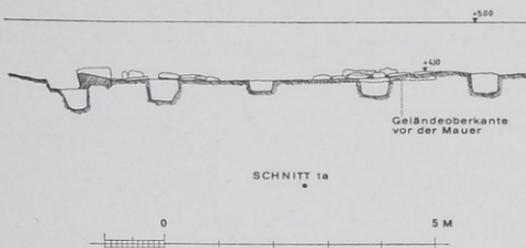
Bau III. Querschnitt, M 1: 100.
